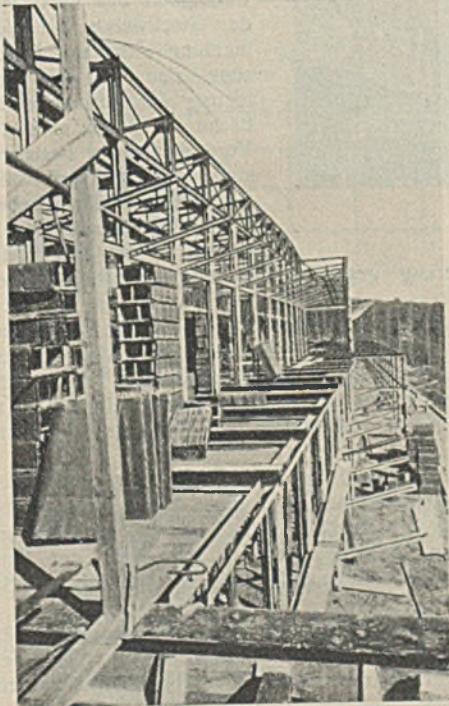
Teil der fertiggestellten Stahlskelettkonstruktion.
